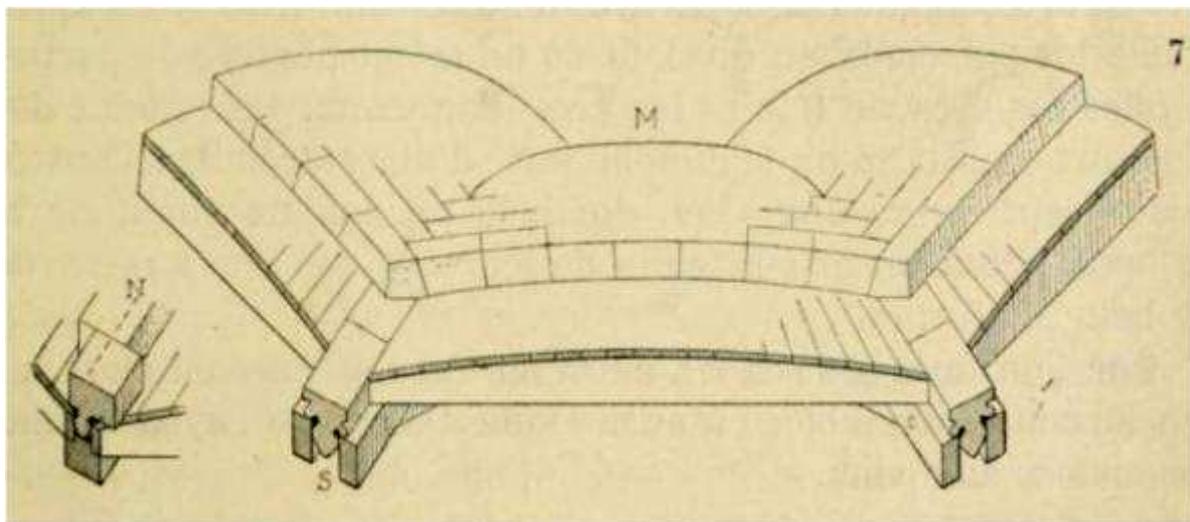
13.3 Tablero como cimbra para las plementerías, según Choisy.
